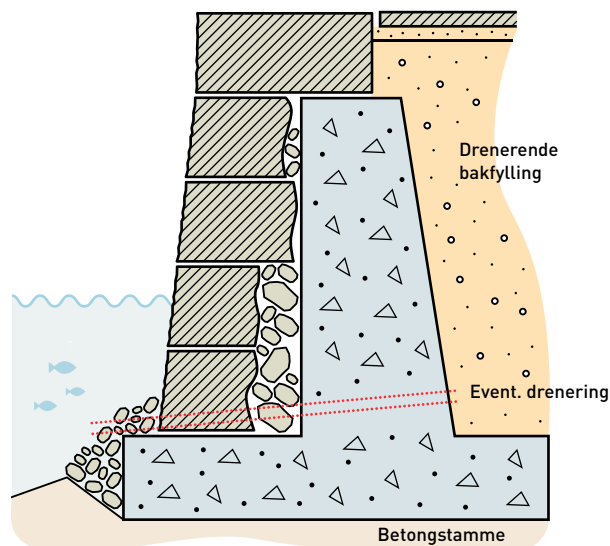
Kaimur. Tørrmur montert på betongstamme.
